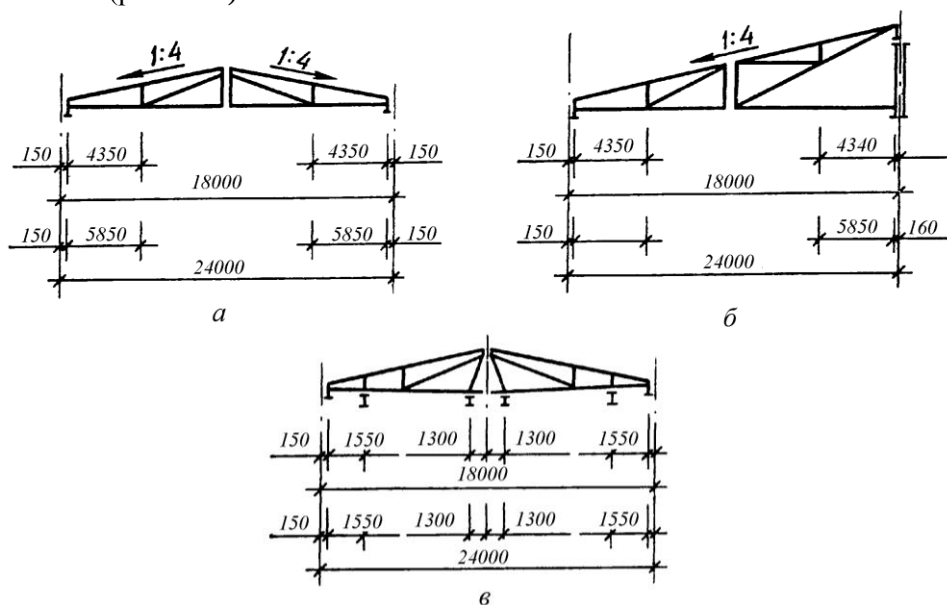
Уніфіковані схеми трикутних ферм для холодної покрівлі:
